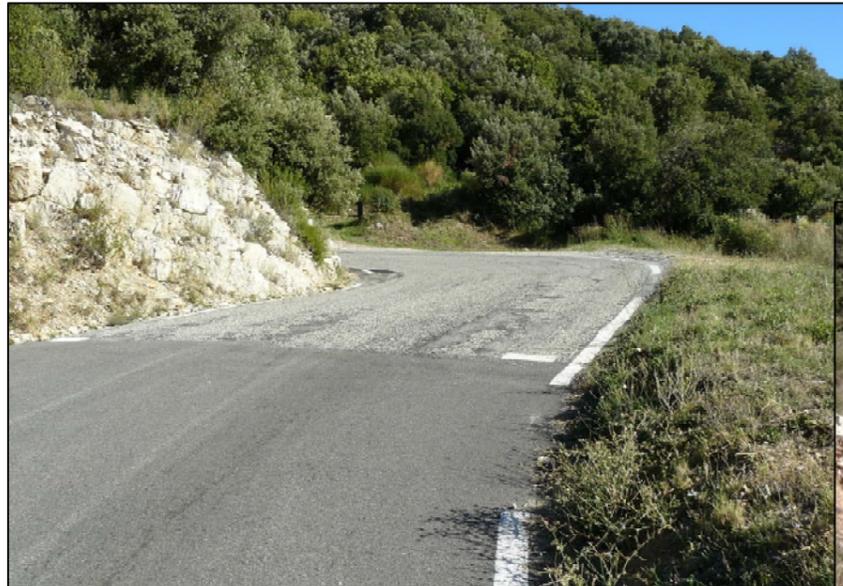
Passage de la chaussée "rénovée" à la chaussée "dégradée"
